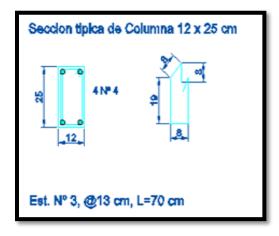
Corte transversal columna 12x25 cm Fuente. Autor del proyecto
